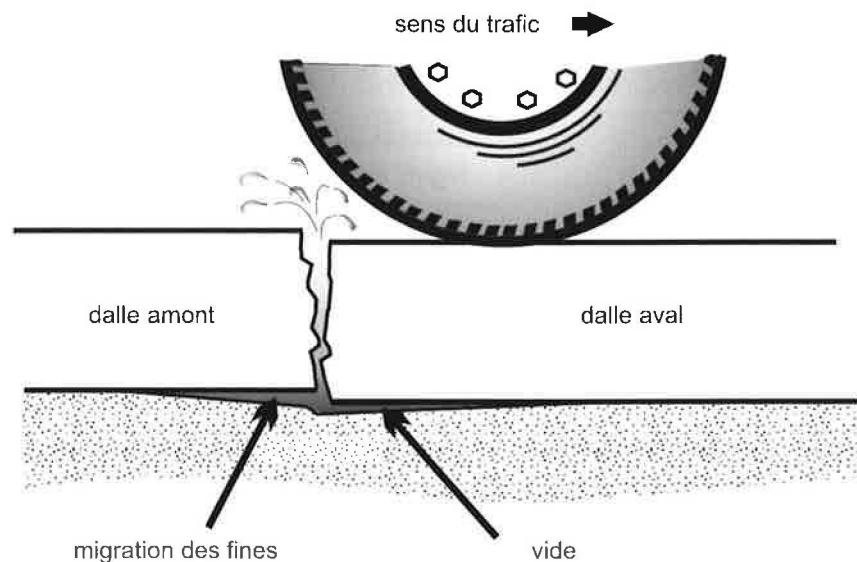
Pompage au droit d'un joint transversal et mise en marche d'escalier
